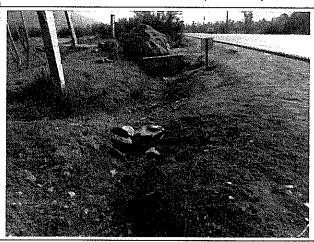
Alcantarilla sin su sección libre en un 90%, foso derecho, kilómetro 37, camino rol G-16. (20-08-2013)
